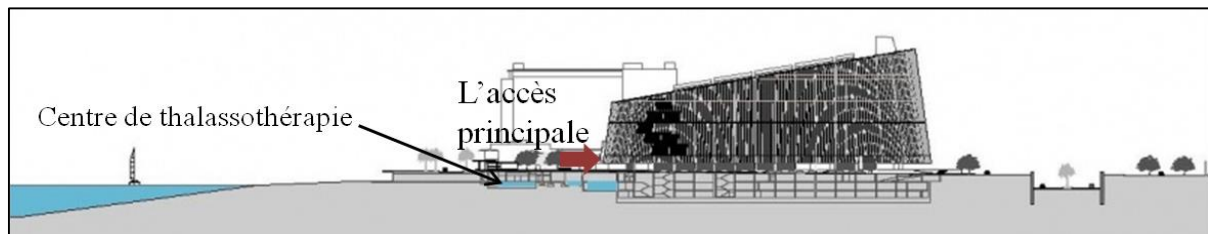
Façade sud – Est. Source : fr.wikiarquitectura.com
